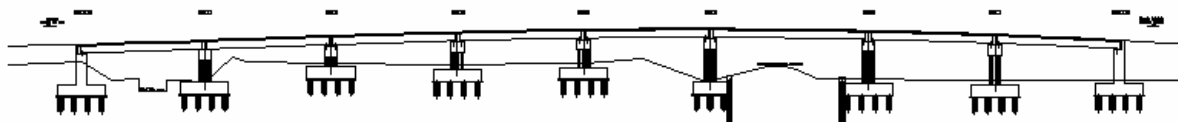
Profilo longitudinale d'insieme del Viadotto E
